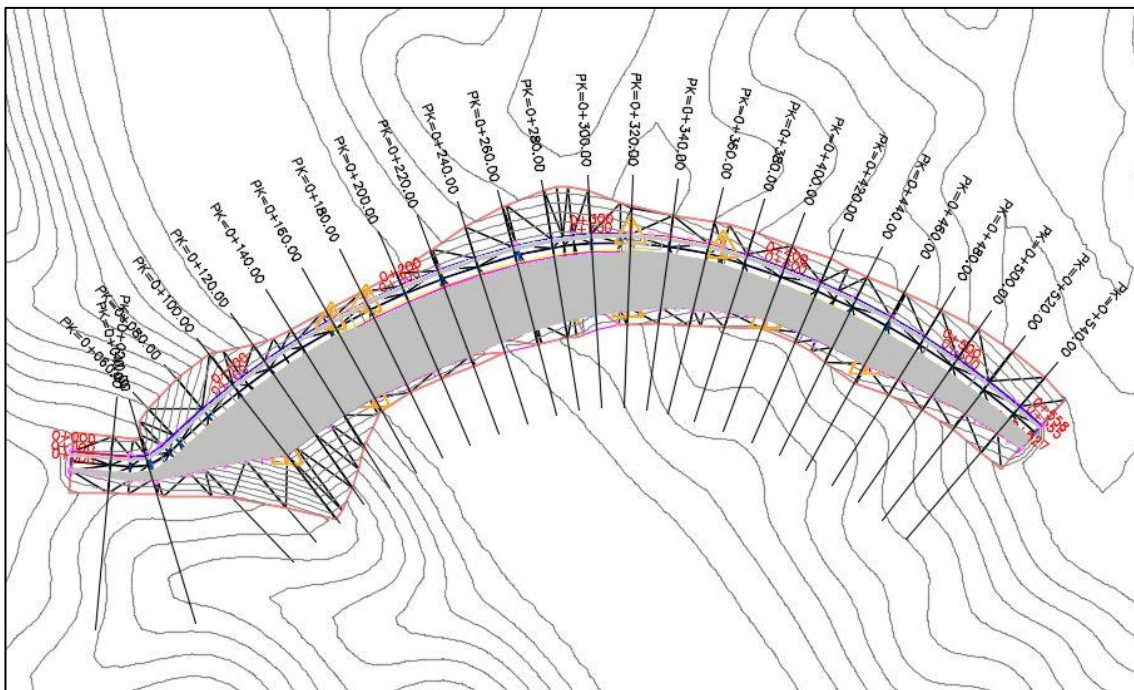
Planta de Presa en la que se definen las zonas por las que se realizarán los perfiles transversales
